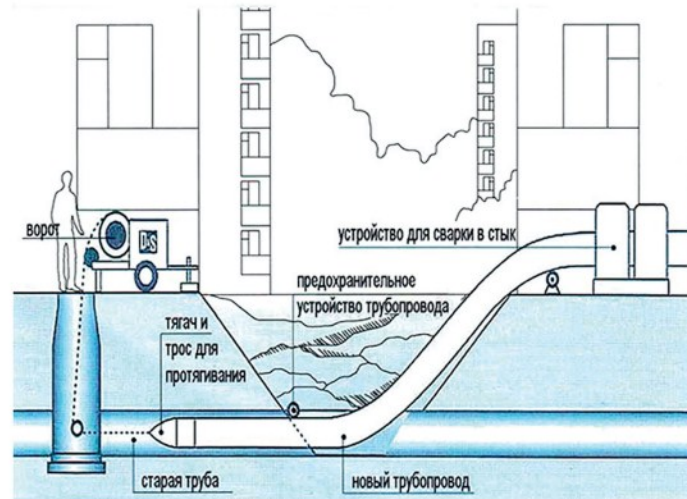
Релайнинг – один из основных способов санации существующих трубопроводов без разрушения старых
